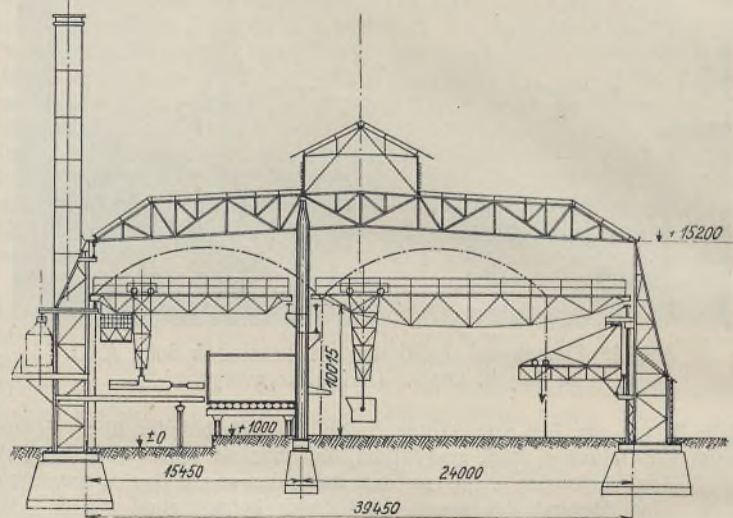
Umbau der Walzwerkshalle eines rheinischen Stahlwerkes. (Querschnitte der alten und der umgebauten neuen Halle.)
